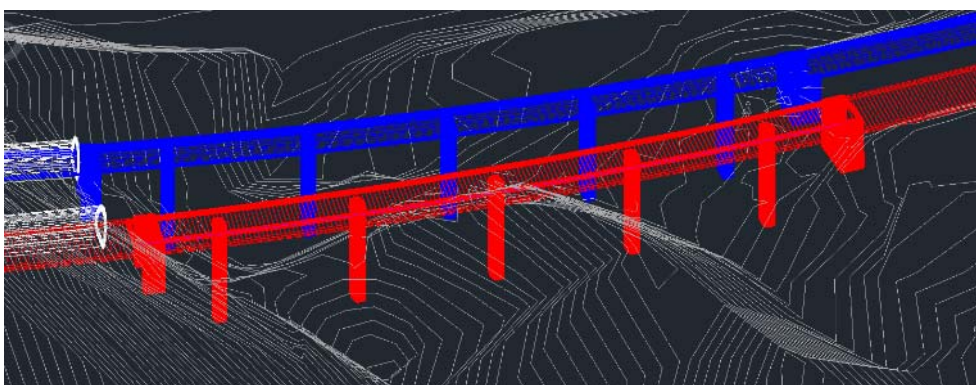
Prikaz pogleda na vijadukt Šum – varijanta 1 (plavo – postojeći, crveno – planirani)
